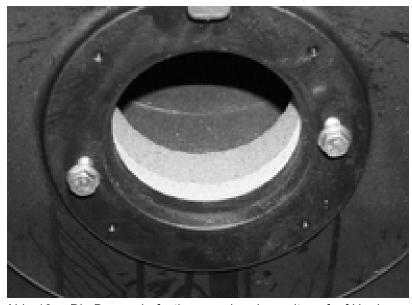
Die Brennerbefestigungsschrauben mit ca. fünf Umdrehungen in die Kesseltür einsetzen.
